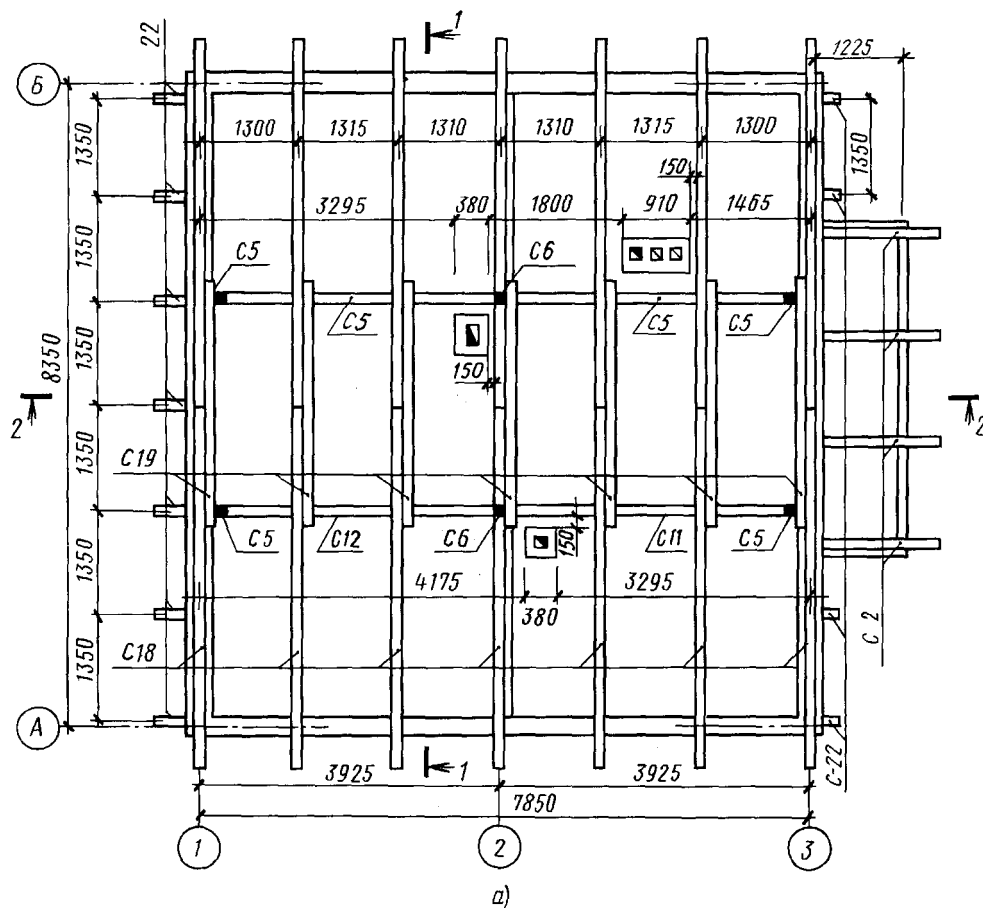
Монтажна схема конструкцій насланих крокв одноповерхового житлового будинку:
